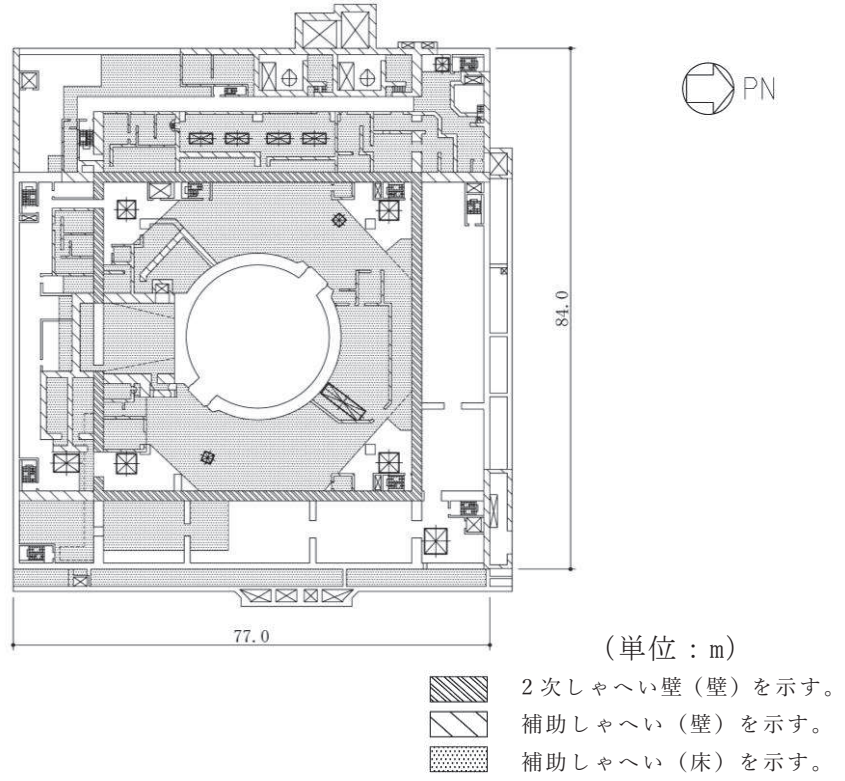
(3) 2次しゃへい壁及び補助しゃへいの範囲の平面図
